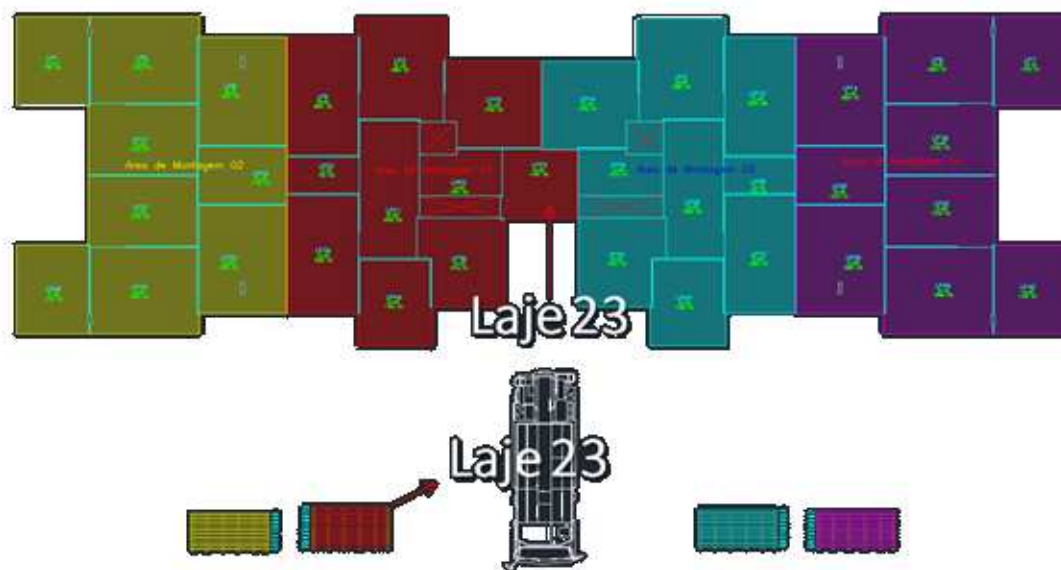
Exemplo de local e ordem do estoque das lajes para içamento em uma obra
